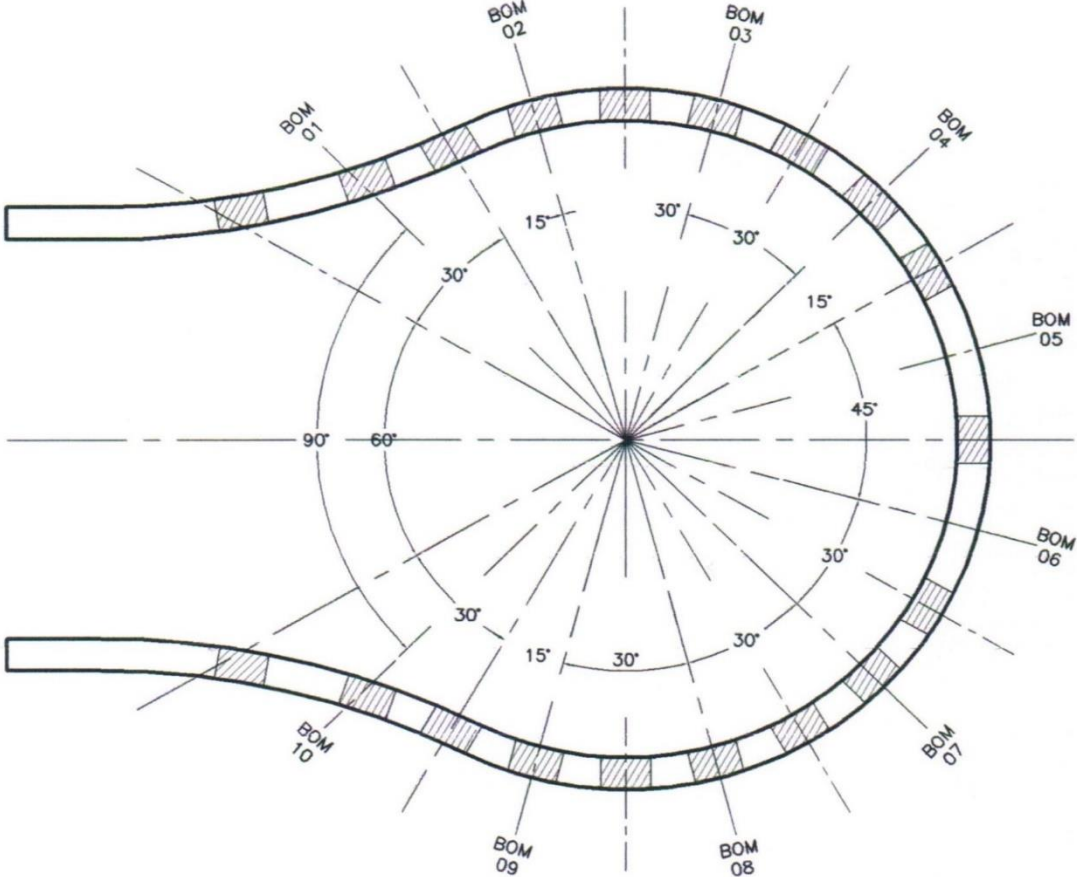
Muro Amortiguador-Vista en Planta
